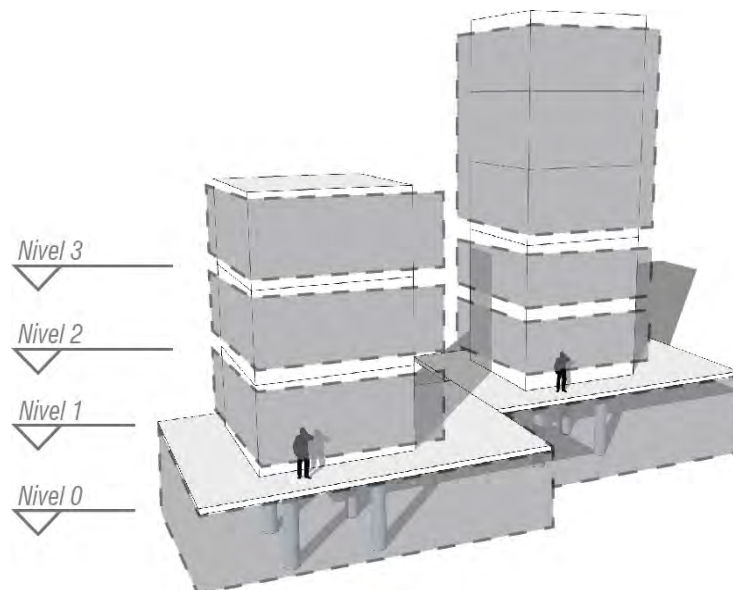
Propuesta master plan conceptualización usos de suelo plan general
